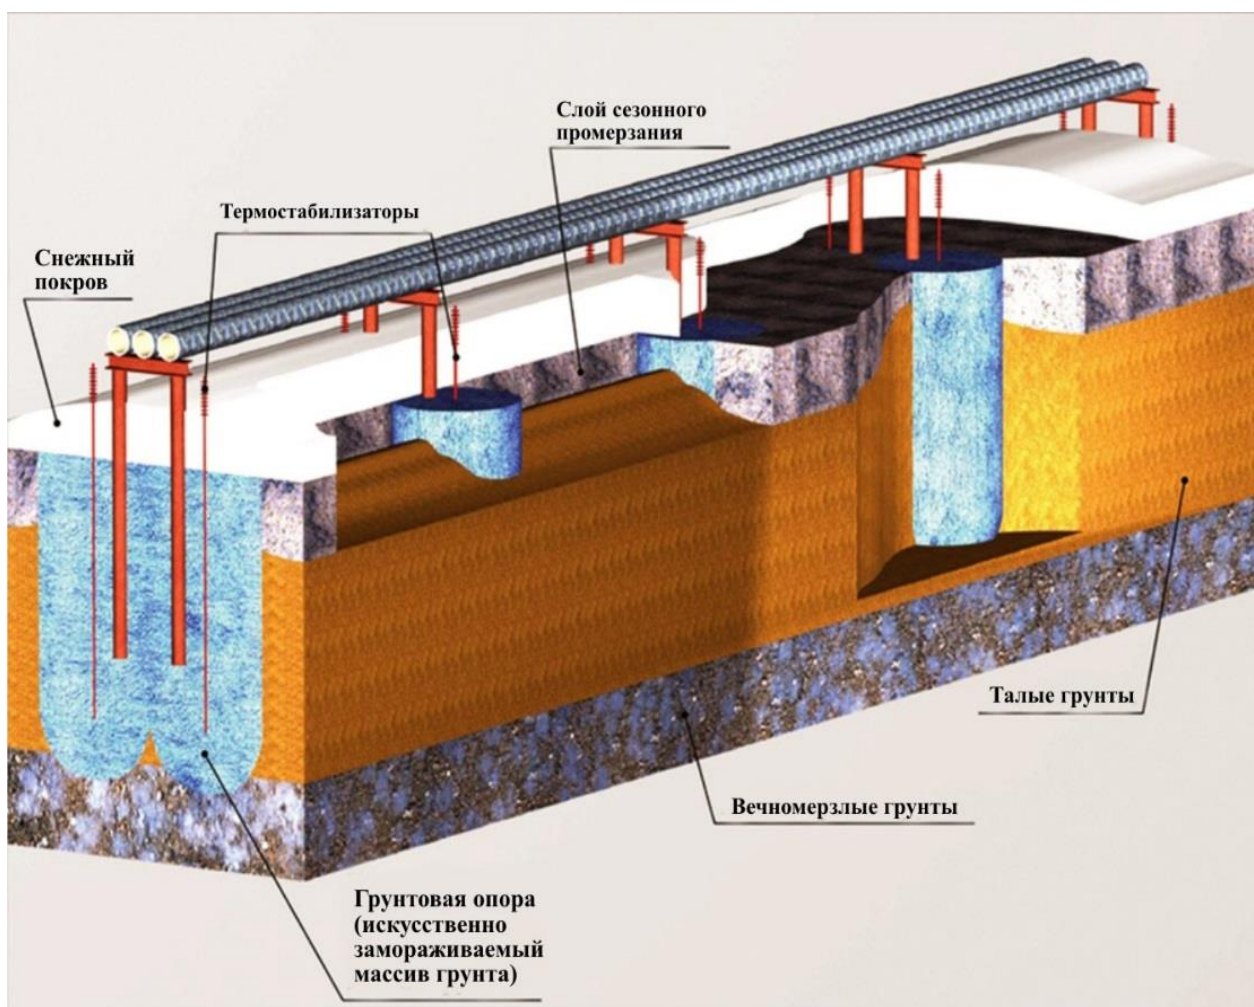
Прокладка теплоизолированного трубопровода на подвижных свайных опорах с термостабилизацией грунтов основания
